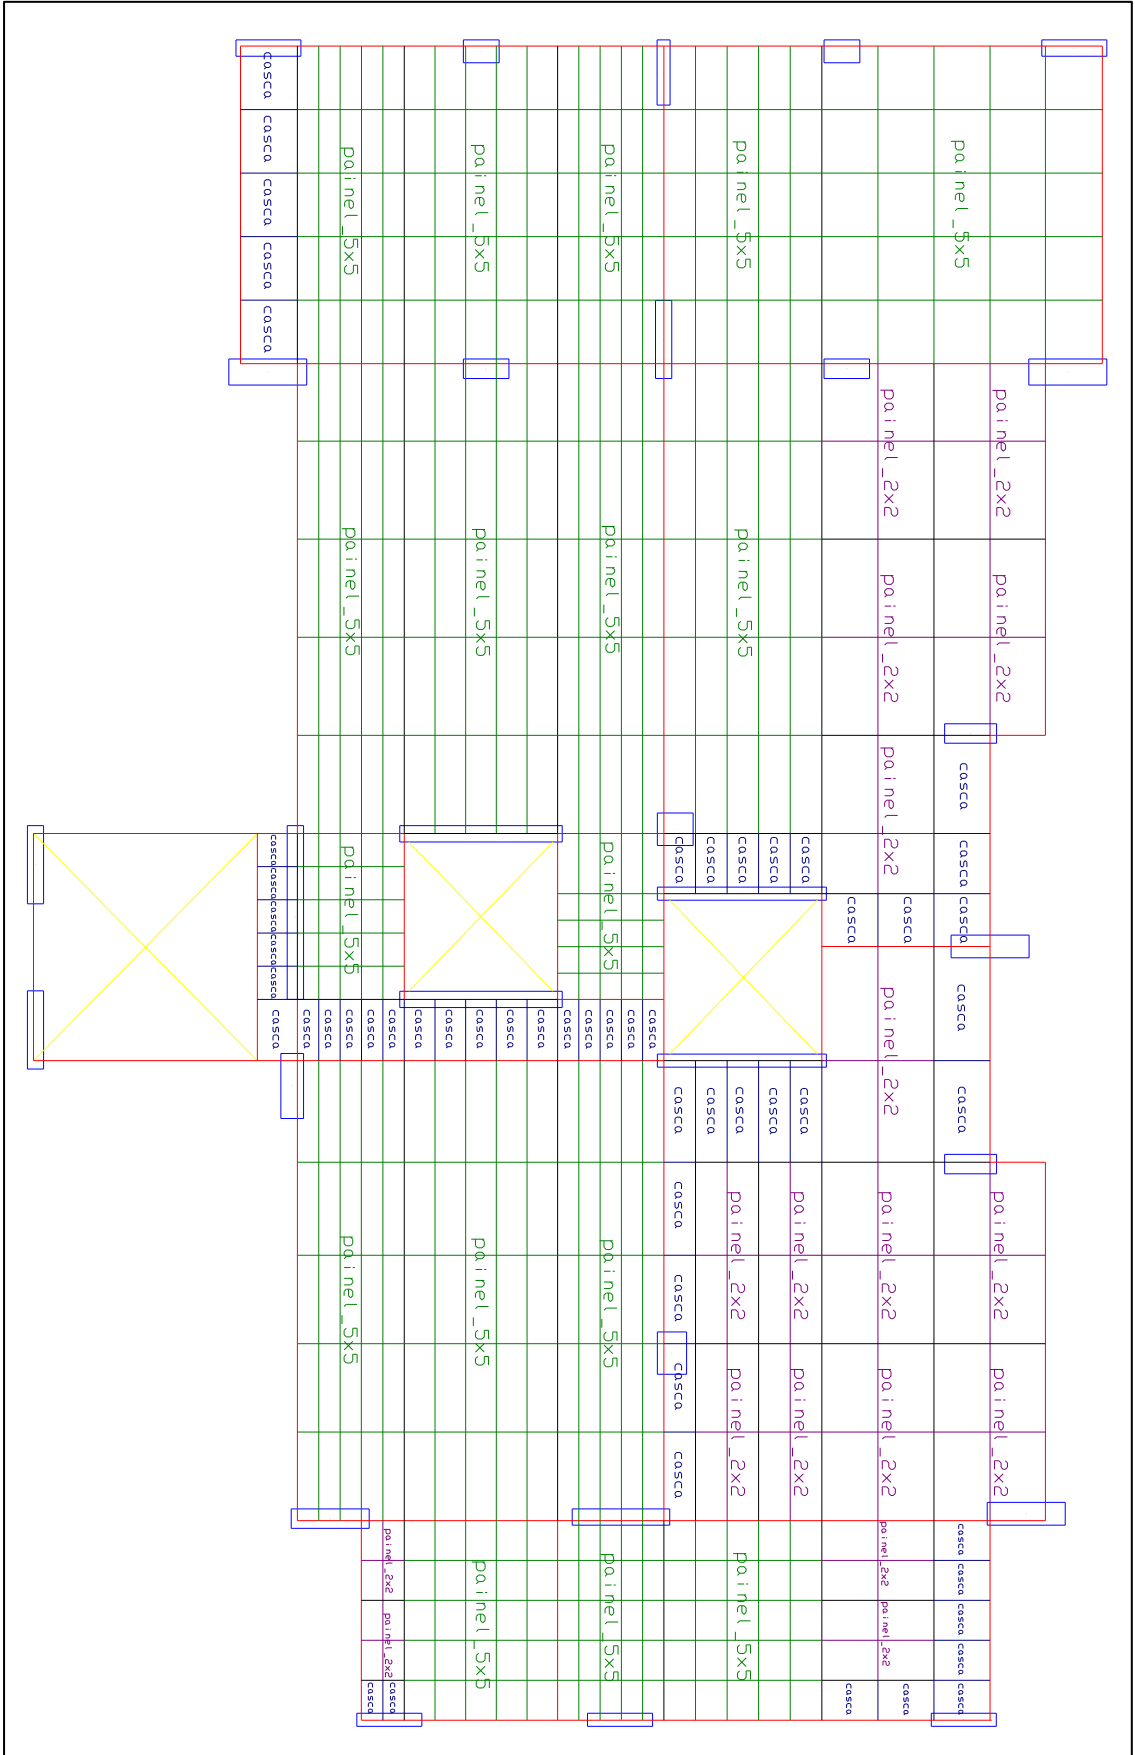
malha de elementos finitos do pavimento tipo – exemplo 4
